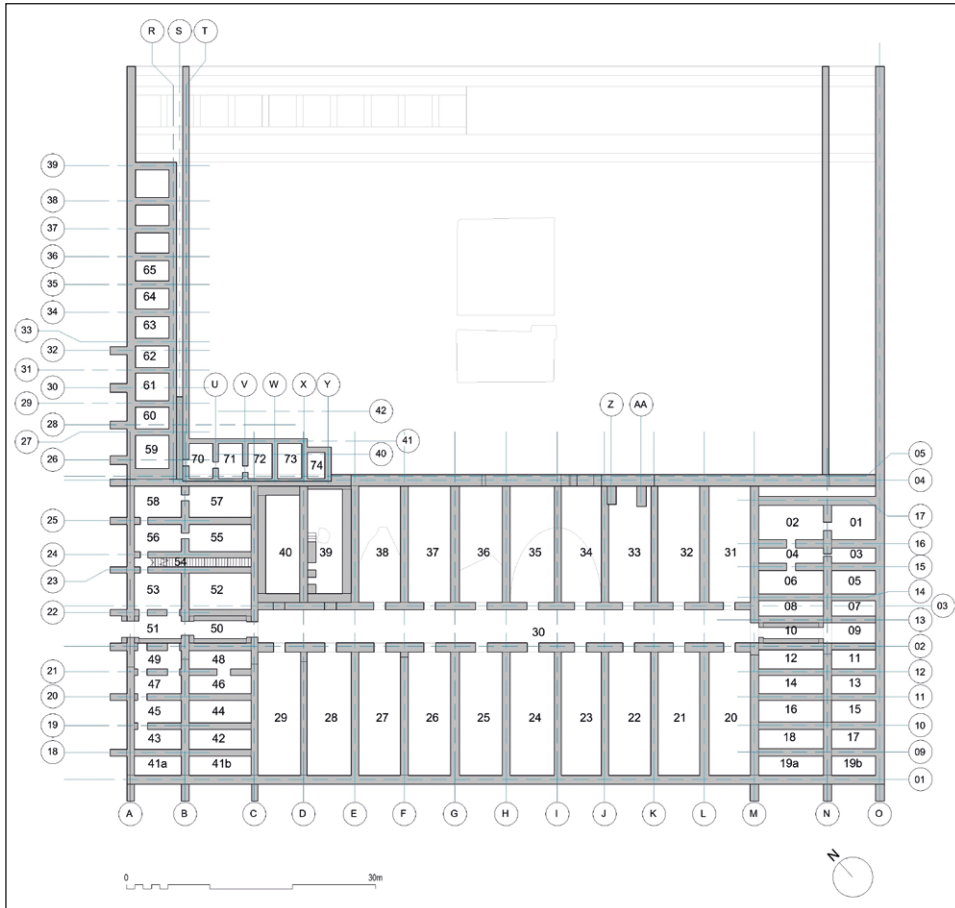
Planta del santuario. Sistema de referencia utilizado para los elementos constructivos y espacios.
